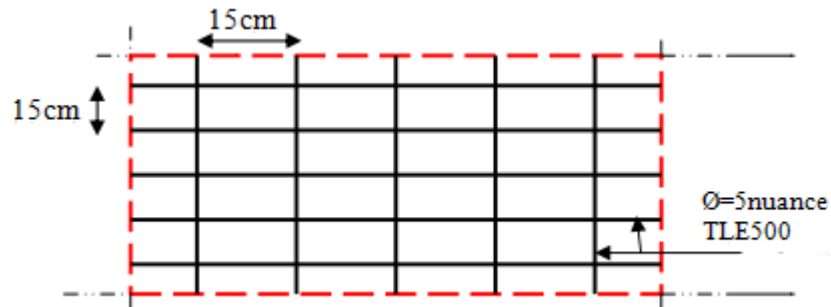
Ferrailage de la dalle de compression avec un treillis soudé (15×15) cm²
